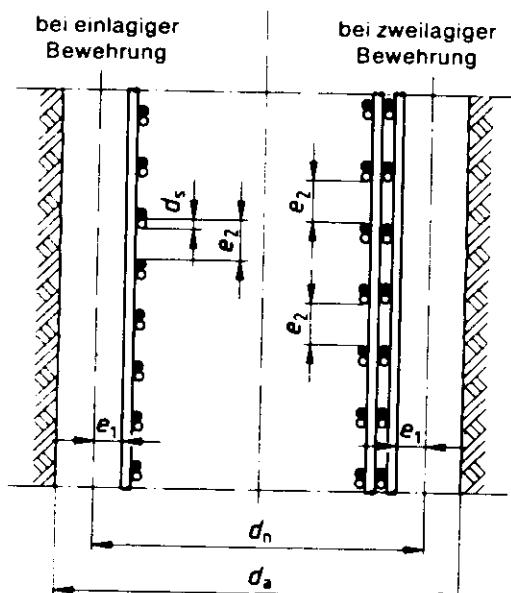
Durchflußweite zur Sicherung der Betondeckung und Bewehrungsanordnung an Stoßstellen
